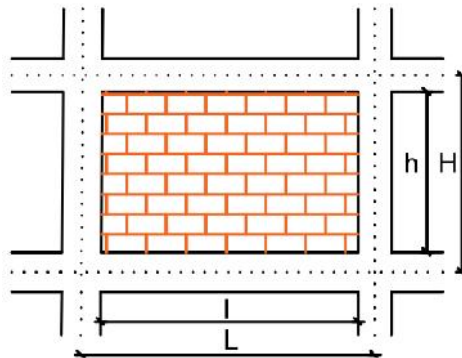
Painel de alvenaria, vigas e pilares confinantes.
